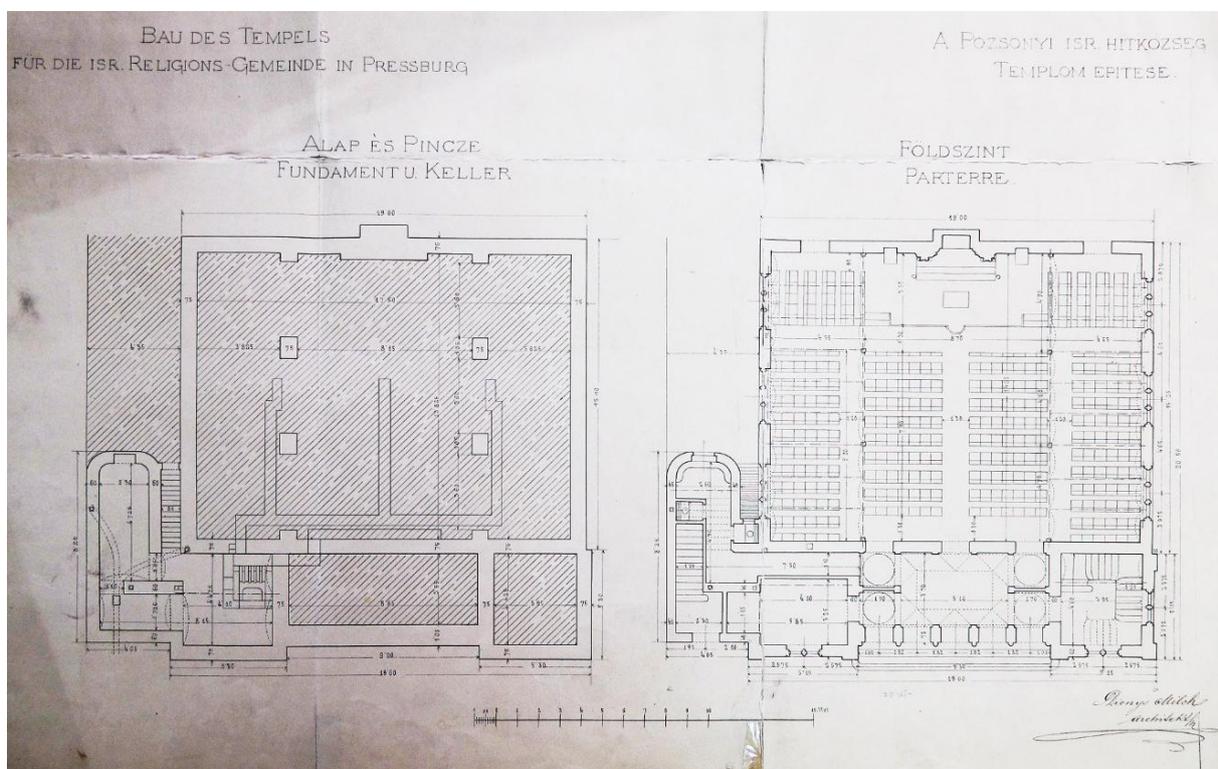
Einreichplan 1893 - Keller- und Erdgeschossgrundriss
